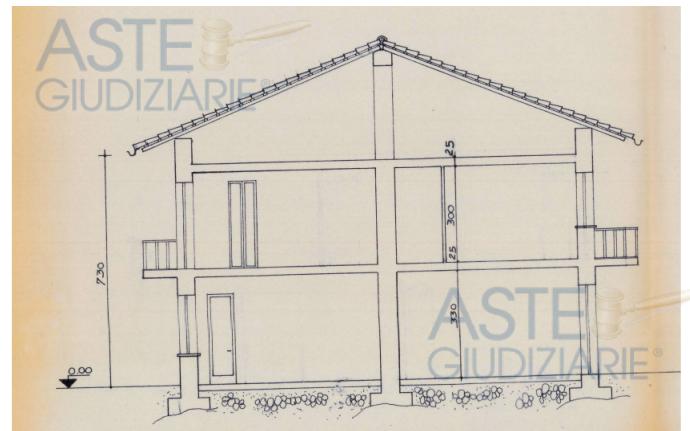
Estratto Concessione in sanatoria ai sensi della Legge 28/2/1985 n.47 prot. 20398
